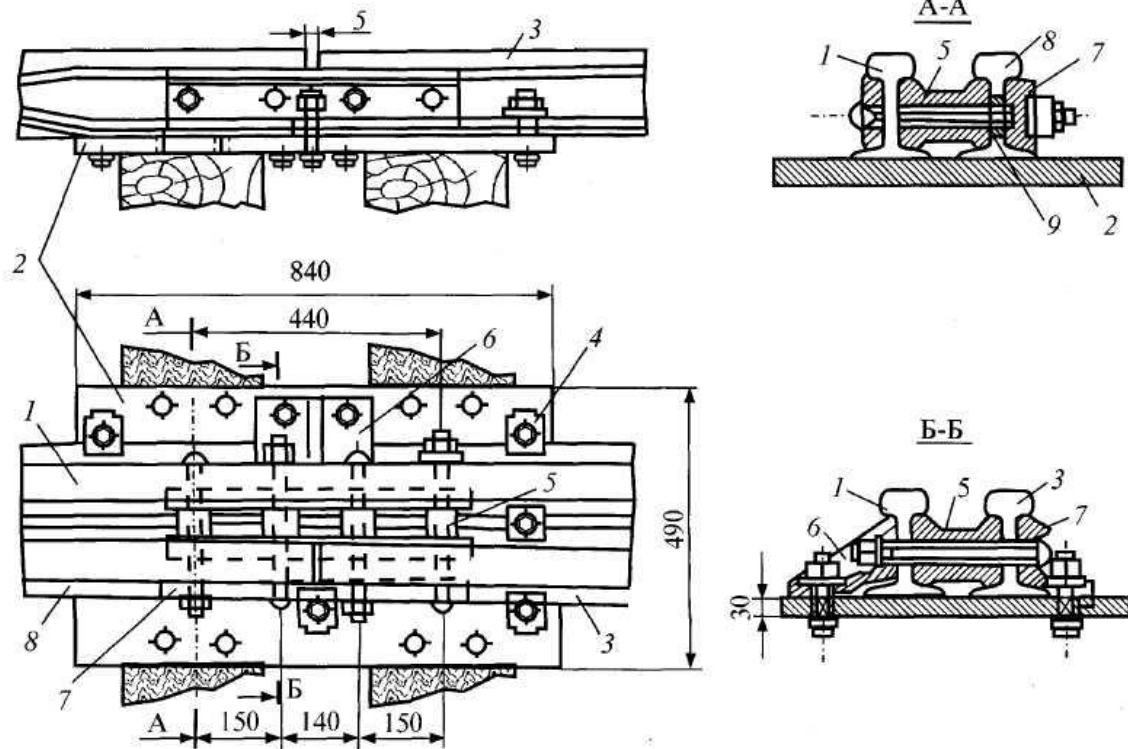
Корневое устройство вкладышно-накладочного типа:
